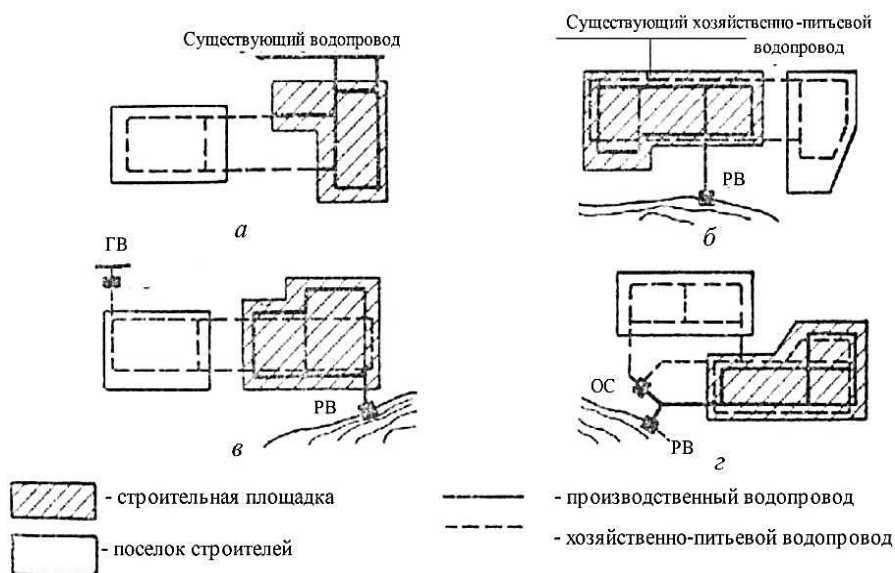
Источники и схемы водоснабжения строительной площадки: РВ – речной водозабор; ГВ – водозабор грунтовых вод; ОС – очистные сооружения
